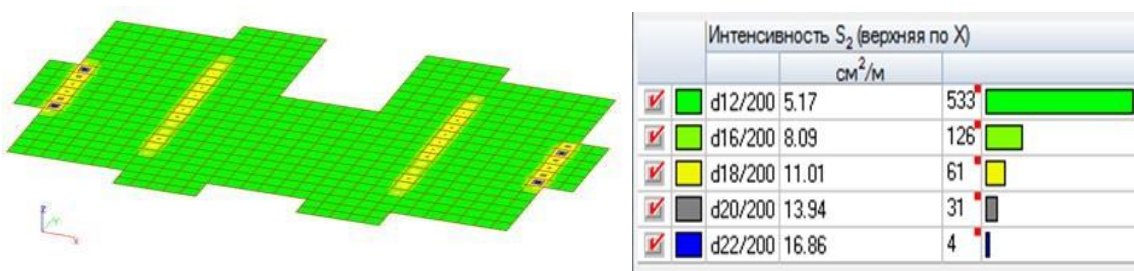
Армирование верхней сетки по оси X плиты типового этажа
